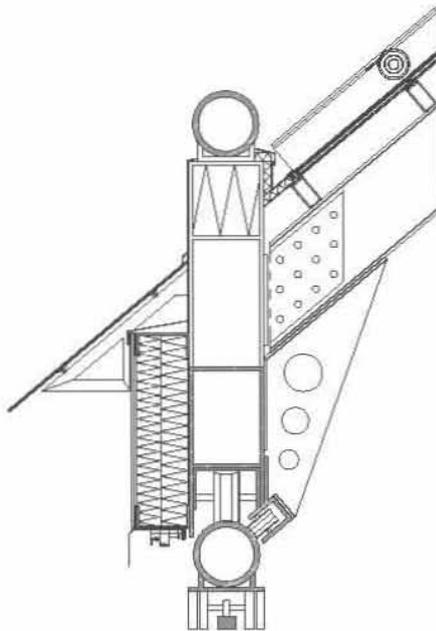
Detailschnitt Dachstuhl M 1:40
